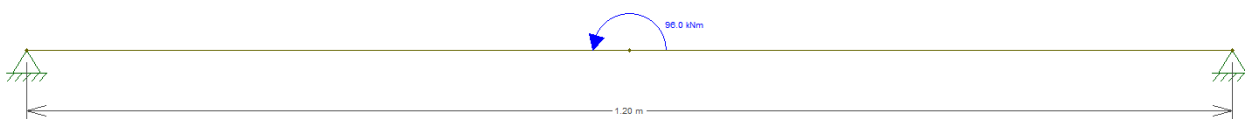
Schema statico sistema gru + pali di fondazione - CASO 2B
